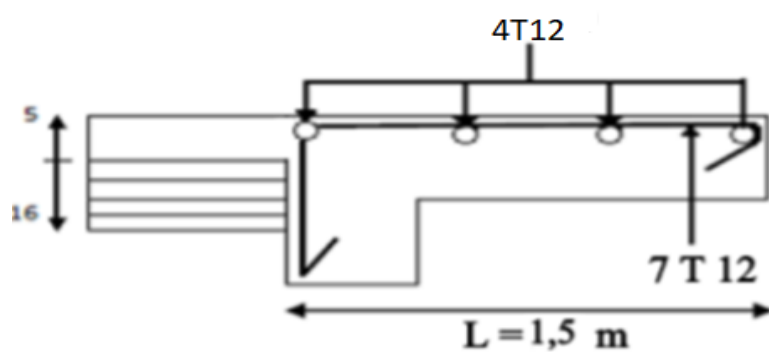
Dessin de ferrailage de la dalle pleine.
